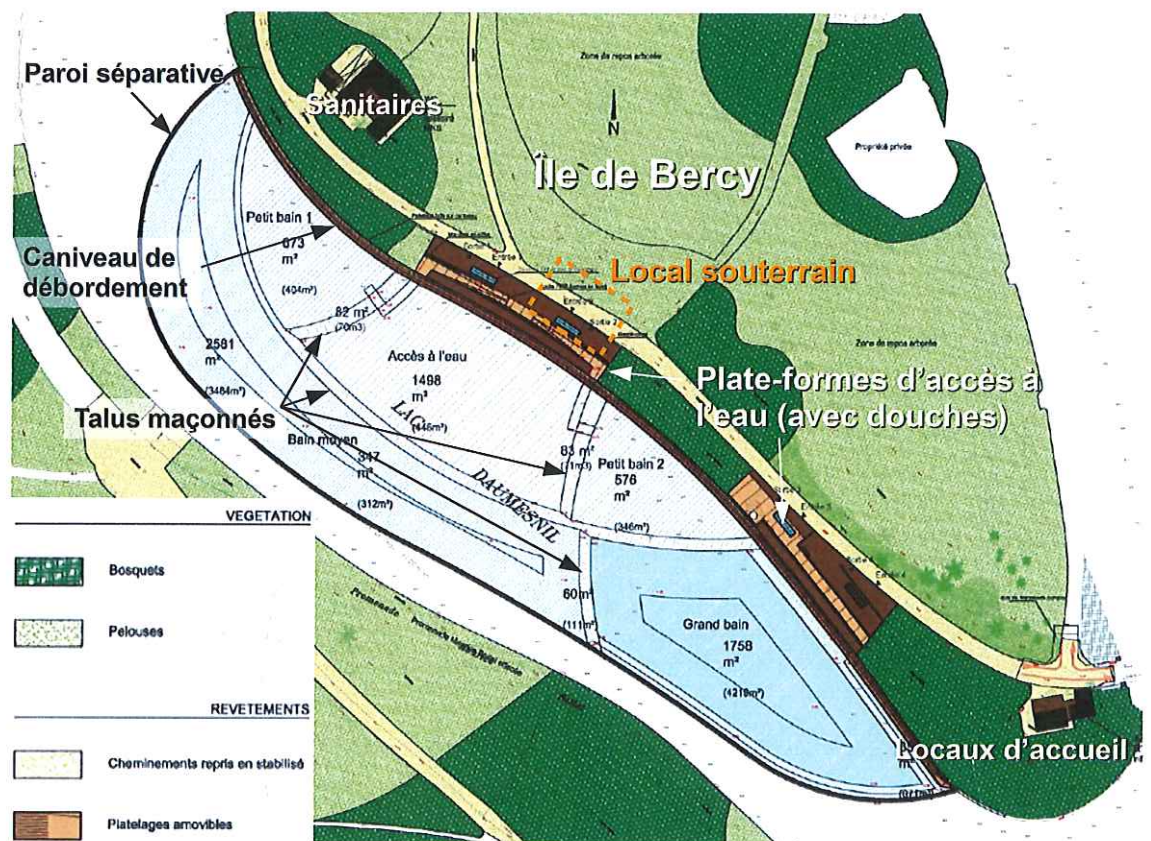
Plan de l'aire de baignade du lac Daumesnil (source : plan masse général ; annotations : DRIEE)
